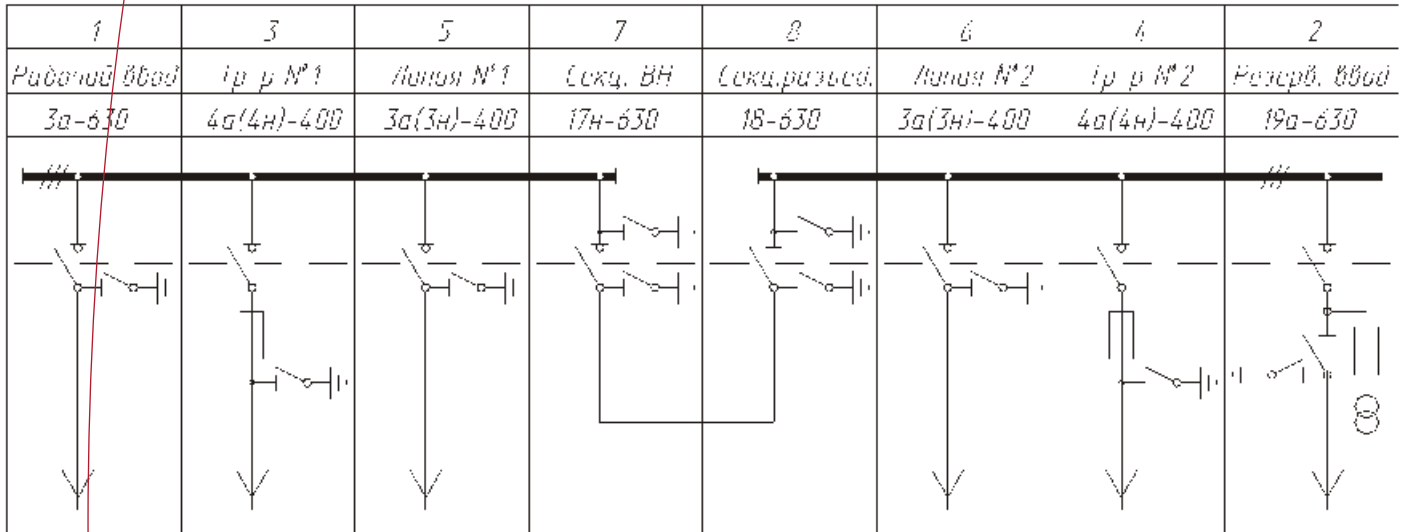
Рекомендуемая схема РУ проходного типа с АВР две секции шин, рабочий и резервный ввод
